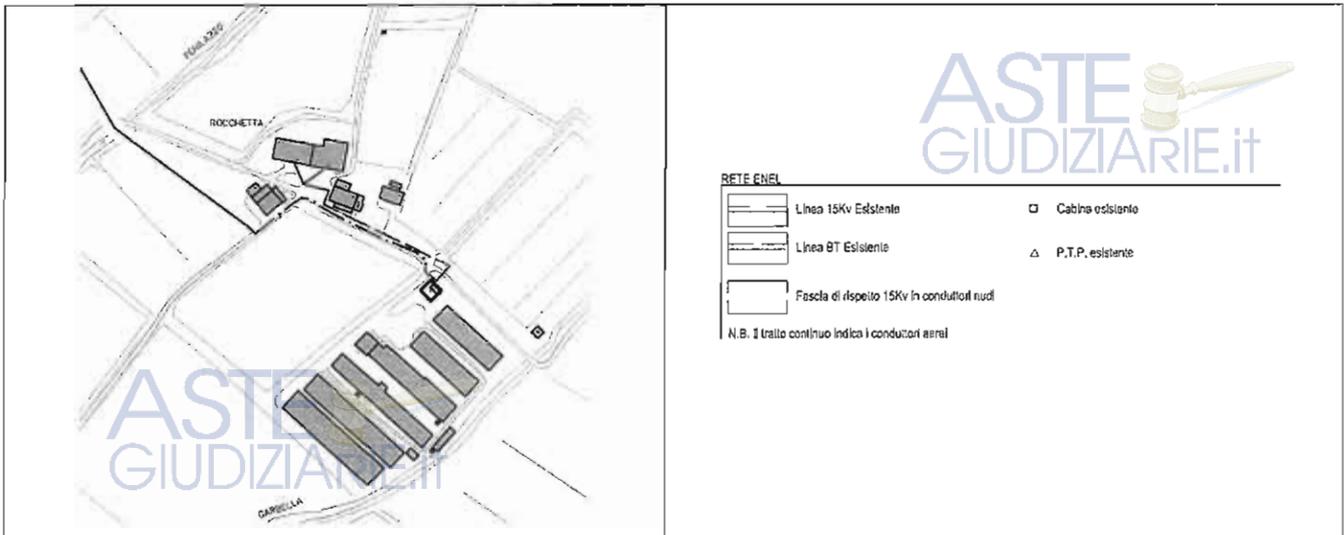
Stralcio P.G.T. – Piano dei Servizi – Stato di fatto dei servizi di infrastrutturazione del sottosuolo
